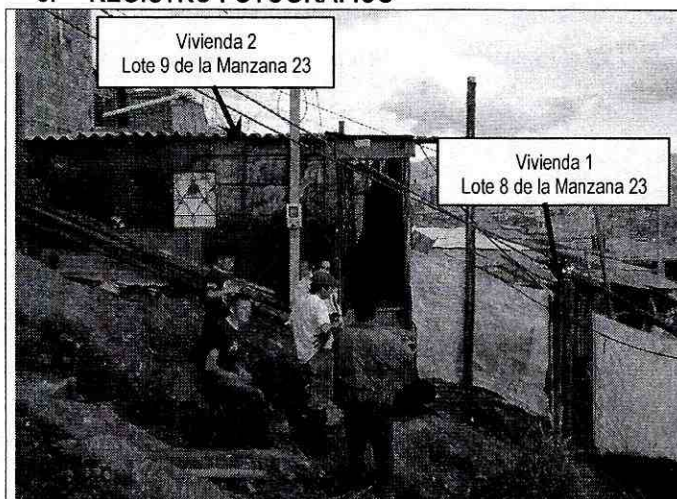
Vista general de las viviendas evaluadas y distribución espacial de las mismas.
